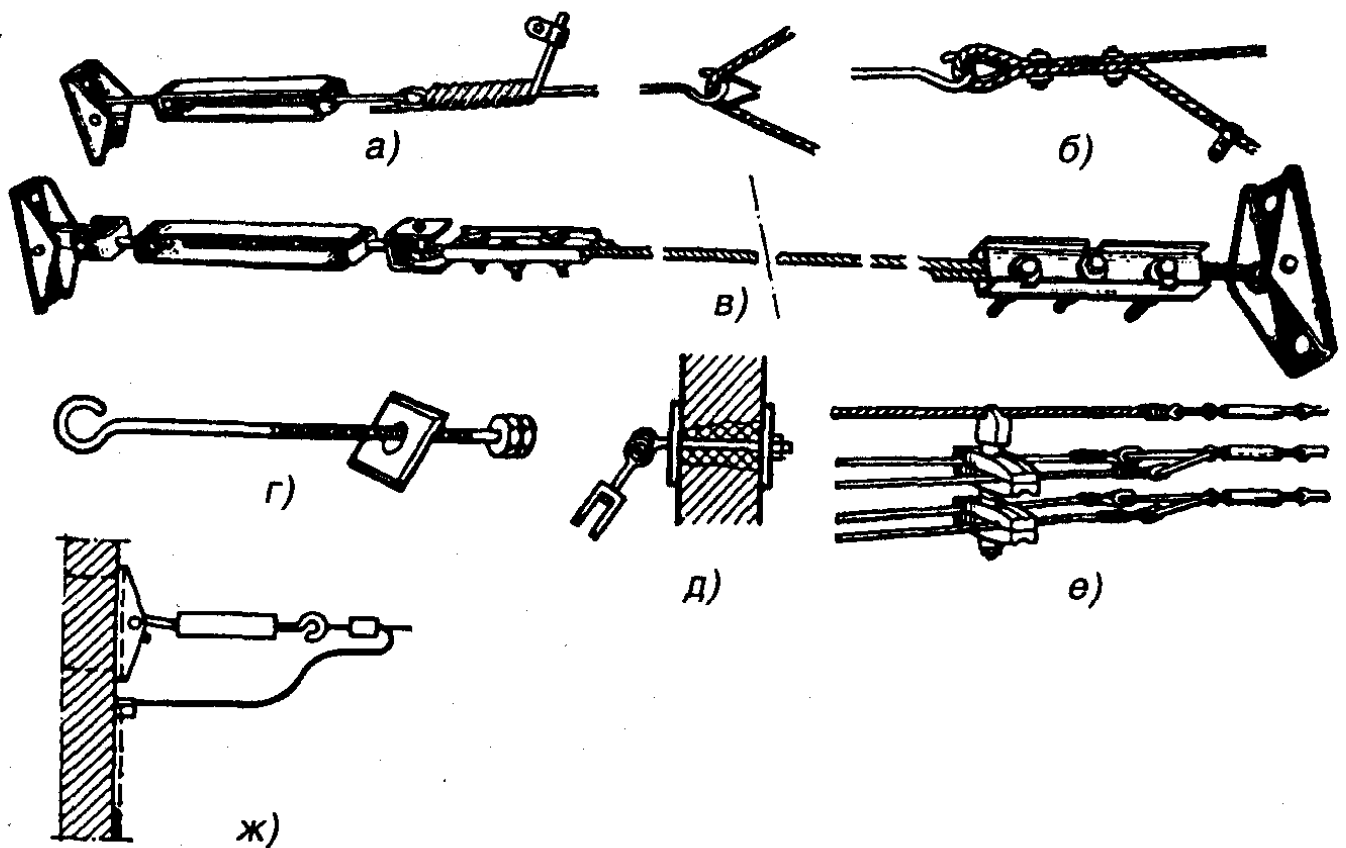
Монтаж элементов тросовых электропроводок:
